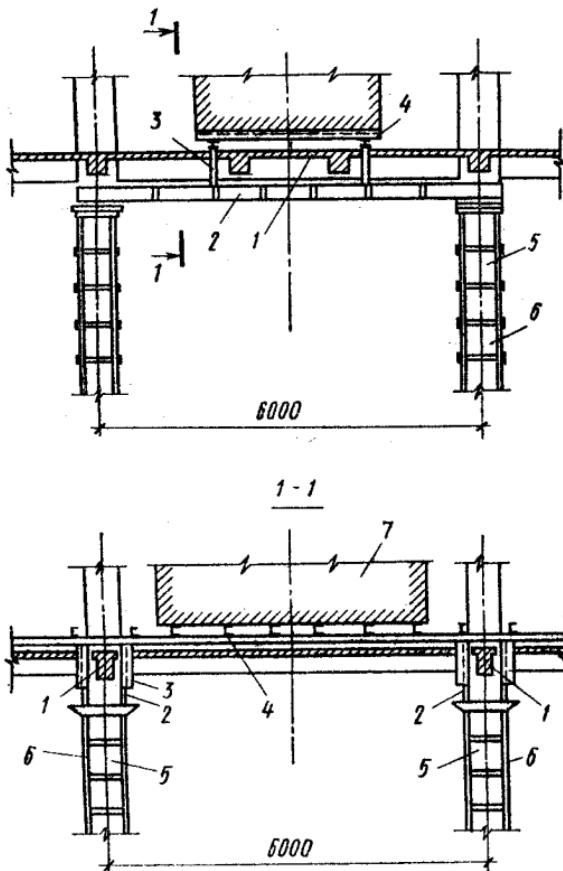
Разгружение плиты перекрытия системой металлических балок снизу:
